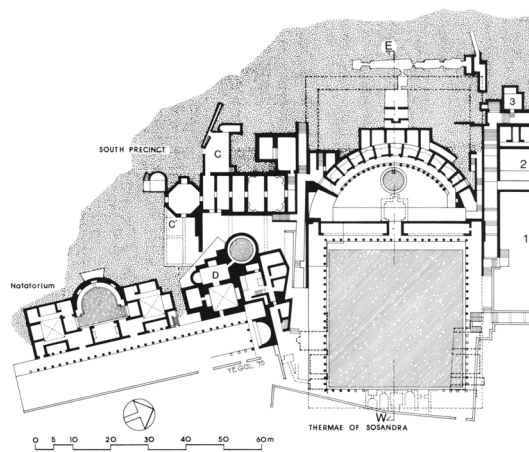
Plano de las termas de Sosandra.⁴⁰⁹
